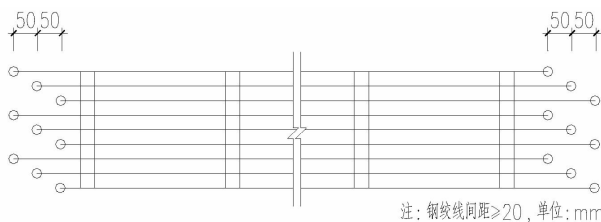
(a) 钢绞线网端部错开锚固示意图
